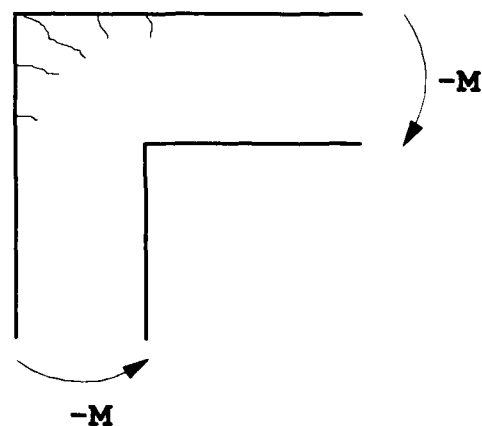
負の曲げモーメントが作用する場合のひび割れパターン
